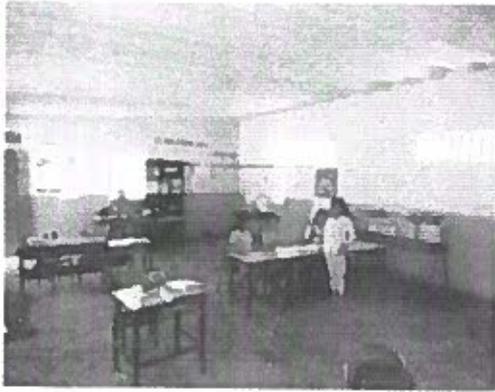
y 03: Vista aula, se observa fisura en muro
